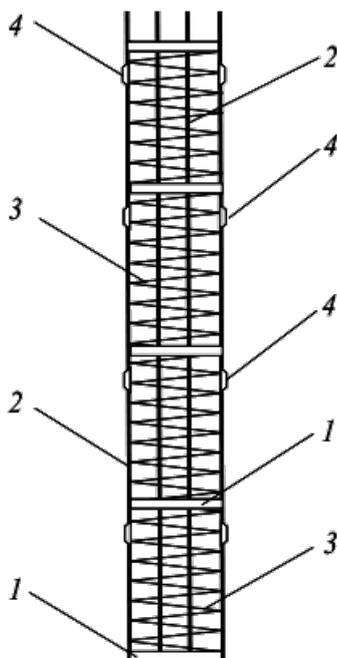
Конструкция арматурного каркаса буронабивной сваи:
